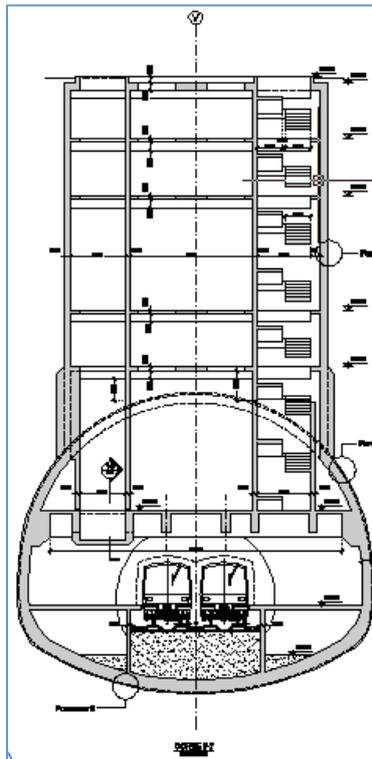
Corte Transversal ao Túnel do Cais na Zona do Poço Principal
